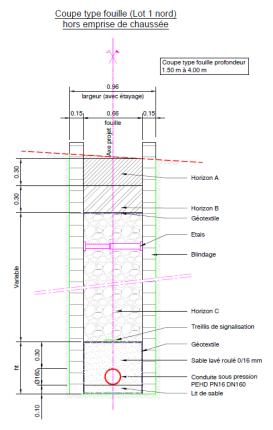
Coupes-type conduite pression hors emprise de chaussée
